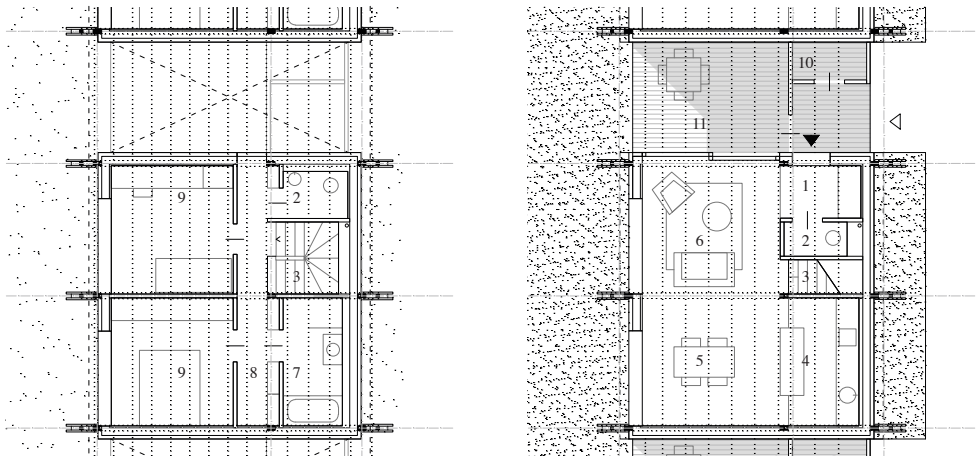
Typ B.1 Regelgeschoße Maisonette Grundrisse
